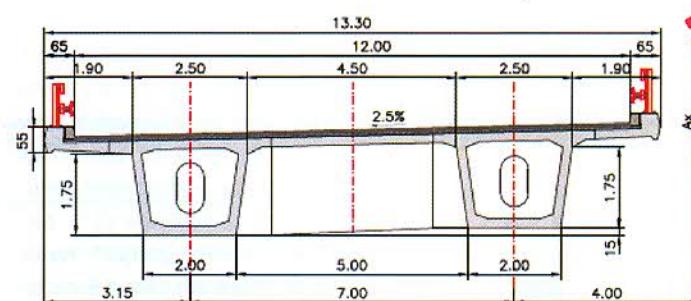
Secțiune transversală tablier din beton precomprimat
